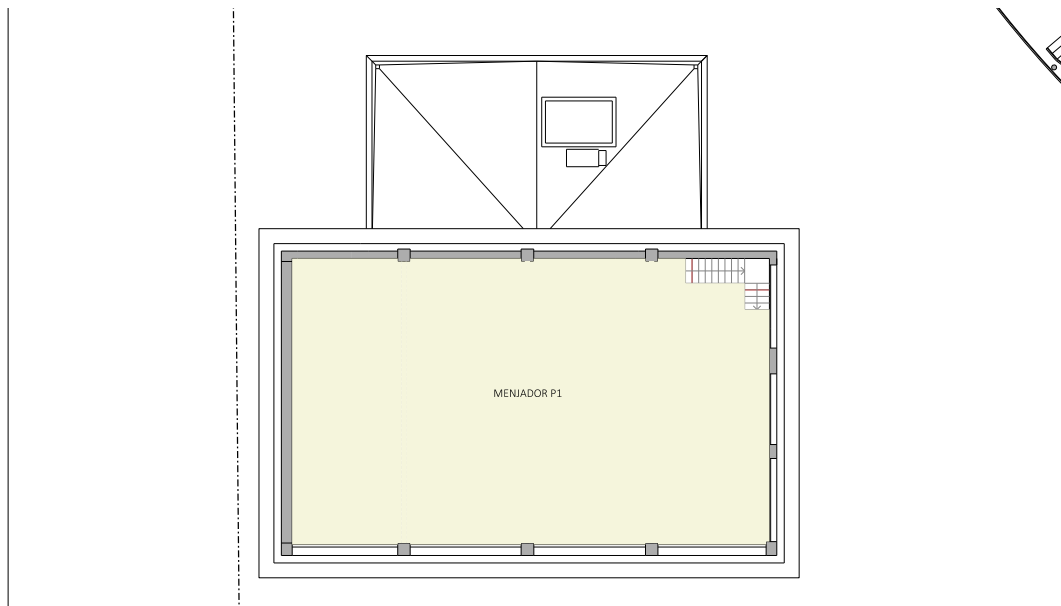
Proposta 3, Edifici E, Planta Primera. Font: Elaboració pròpia.
